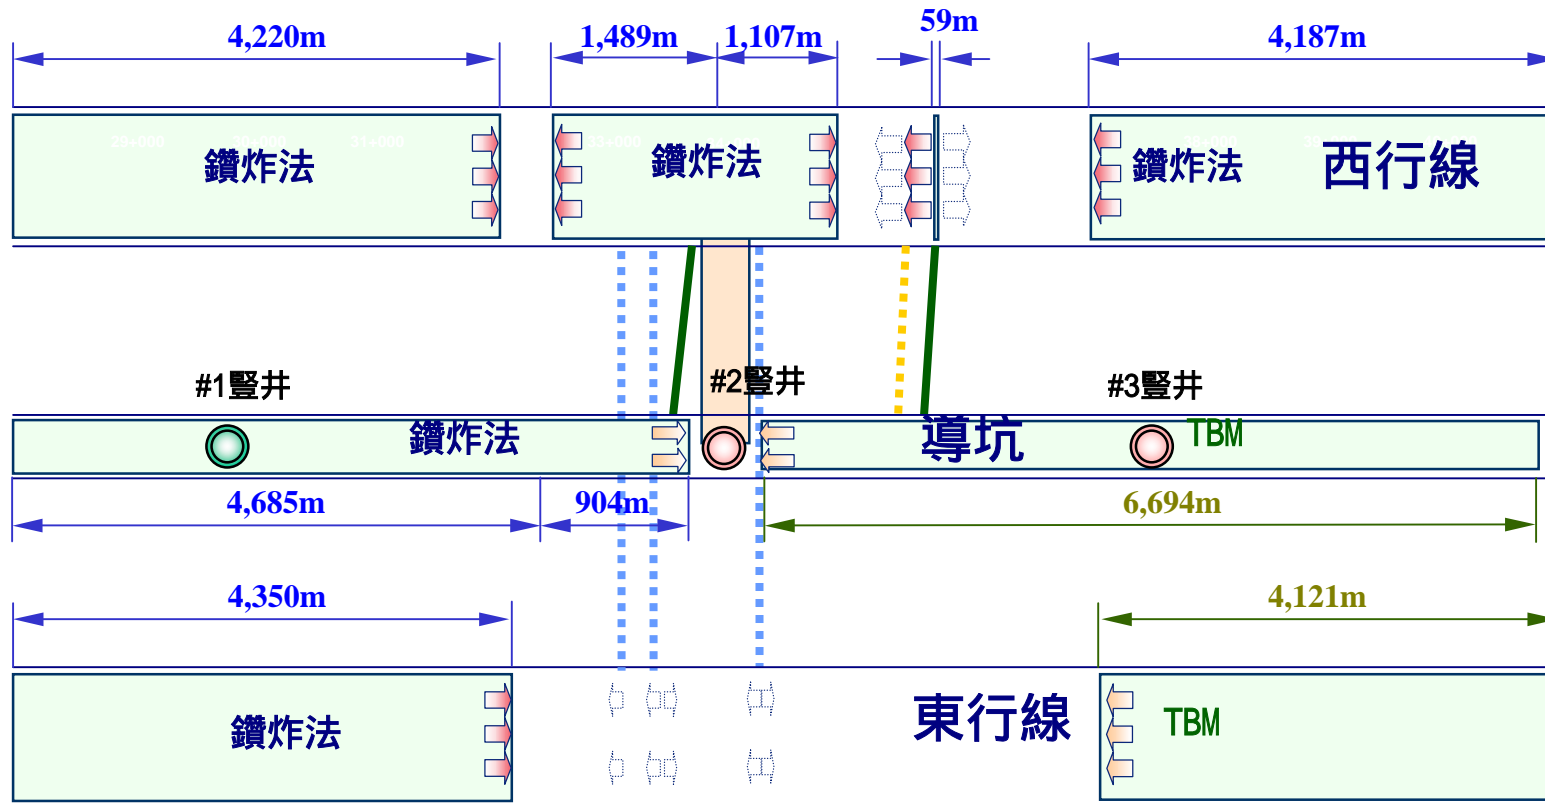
雪山隧道施工改善因應方案平面圖 (88.01.01)
